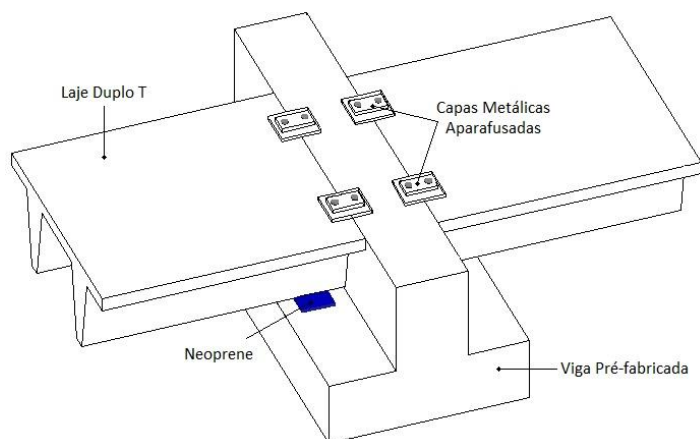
Ligação Laje – Viga central com chapas metálicas aparafusadas
